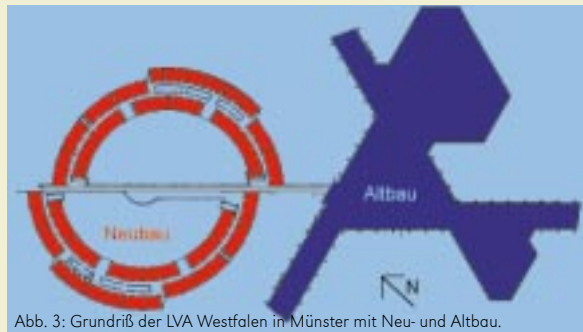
Grundriß der LVA Westfalen in Münster mit Neu- und Altbau.
